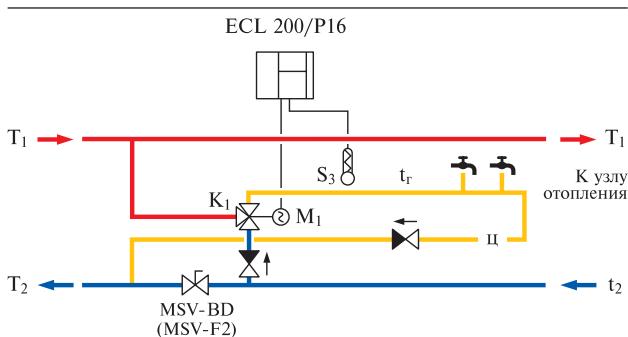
Схема Б-2-(в) узла смешения ГВС с трехходовым клапаном при открытой системе теплоснабжения
